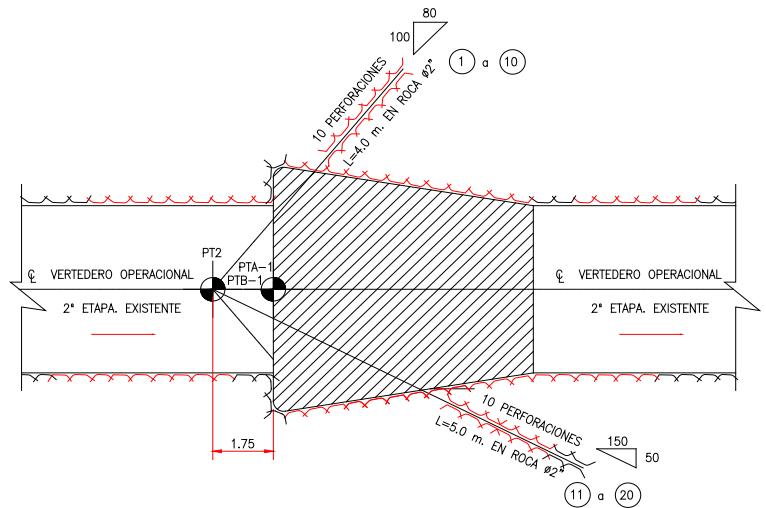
Tapón de Hormigón - Cortina de Inyección de Consolidación.
